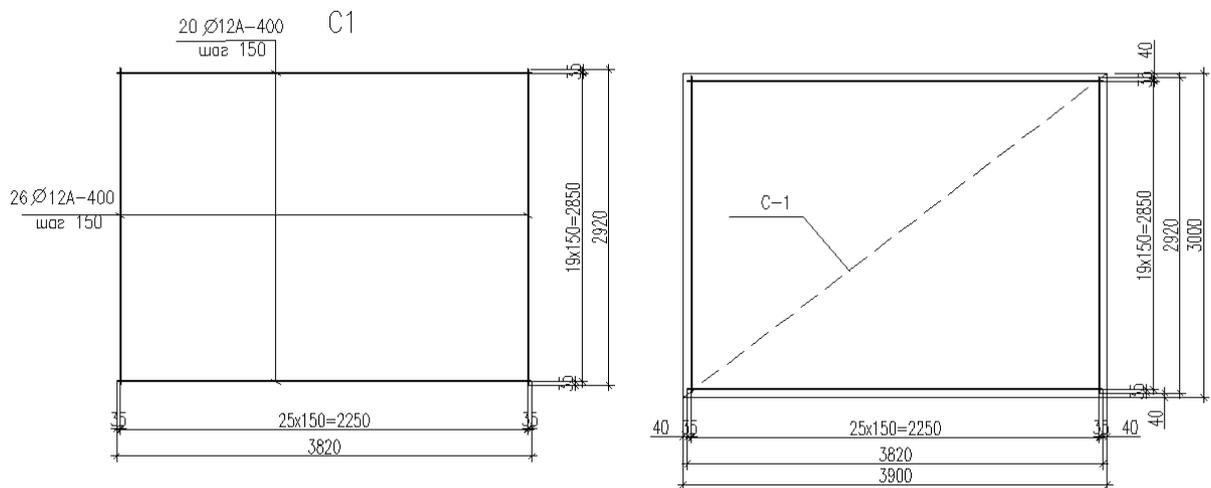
Схема армирования подошвы фундамента ФМЗ-1 Арматурная сетка С-1.
